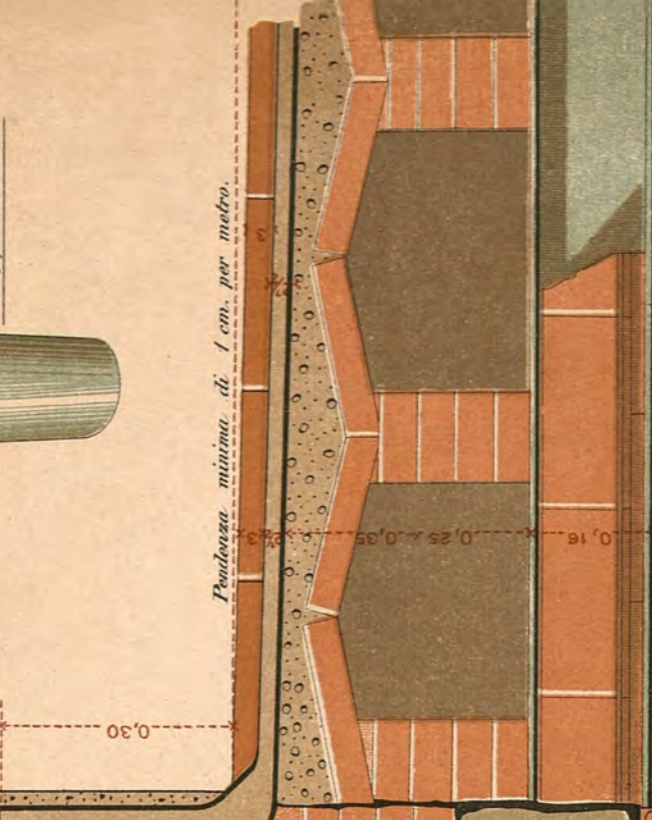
Il particolare, in sezione verticale, del muricciolo delle cunee del camino.
